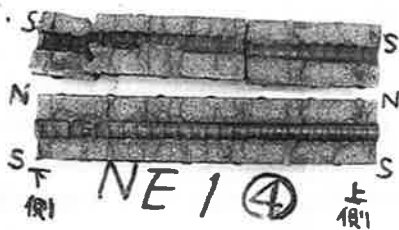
ひび割れ状況（異形鉄筋 ④）
